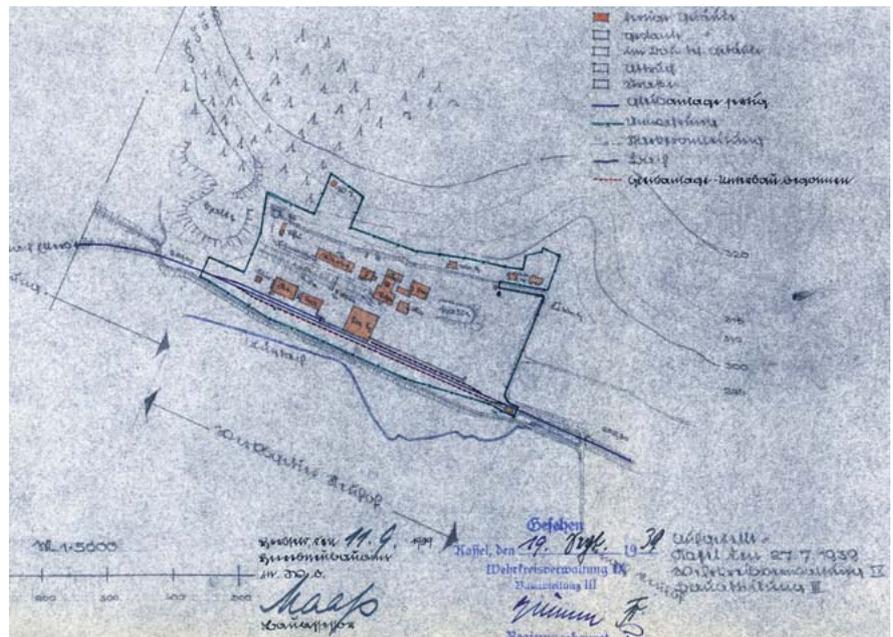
Lageplan Heeresmunitionsanstalt Neuhof
